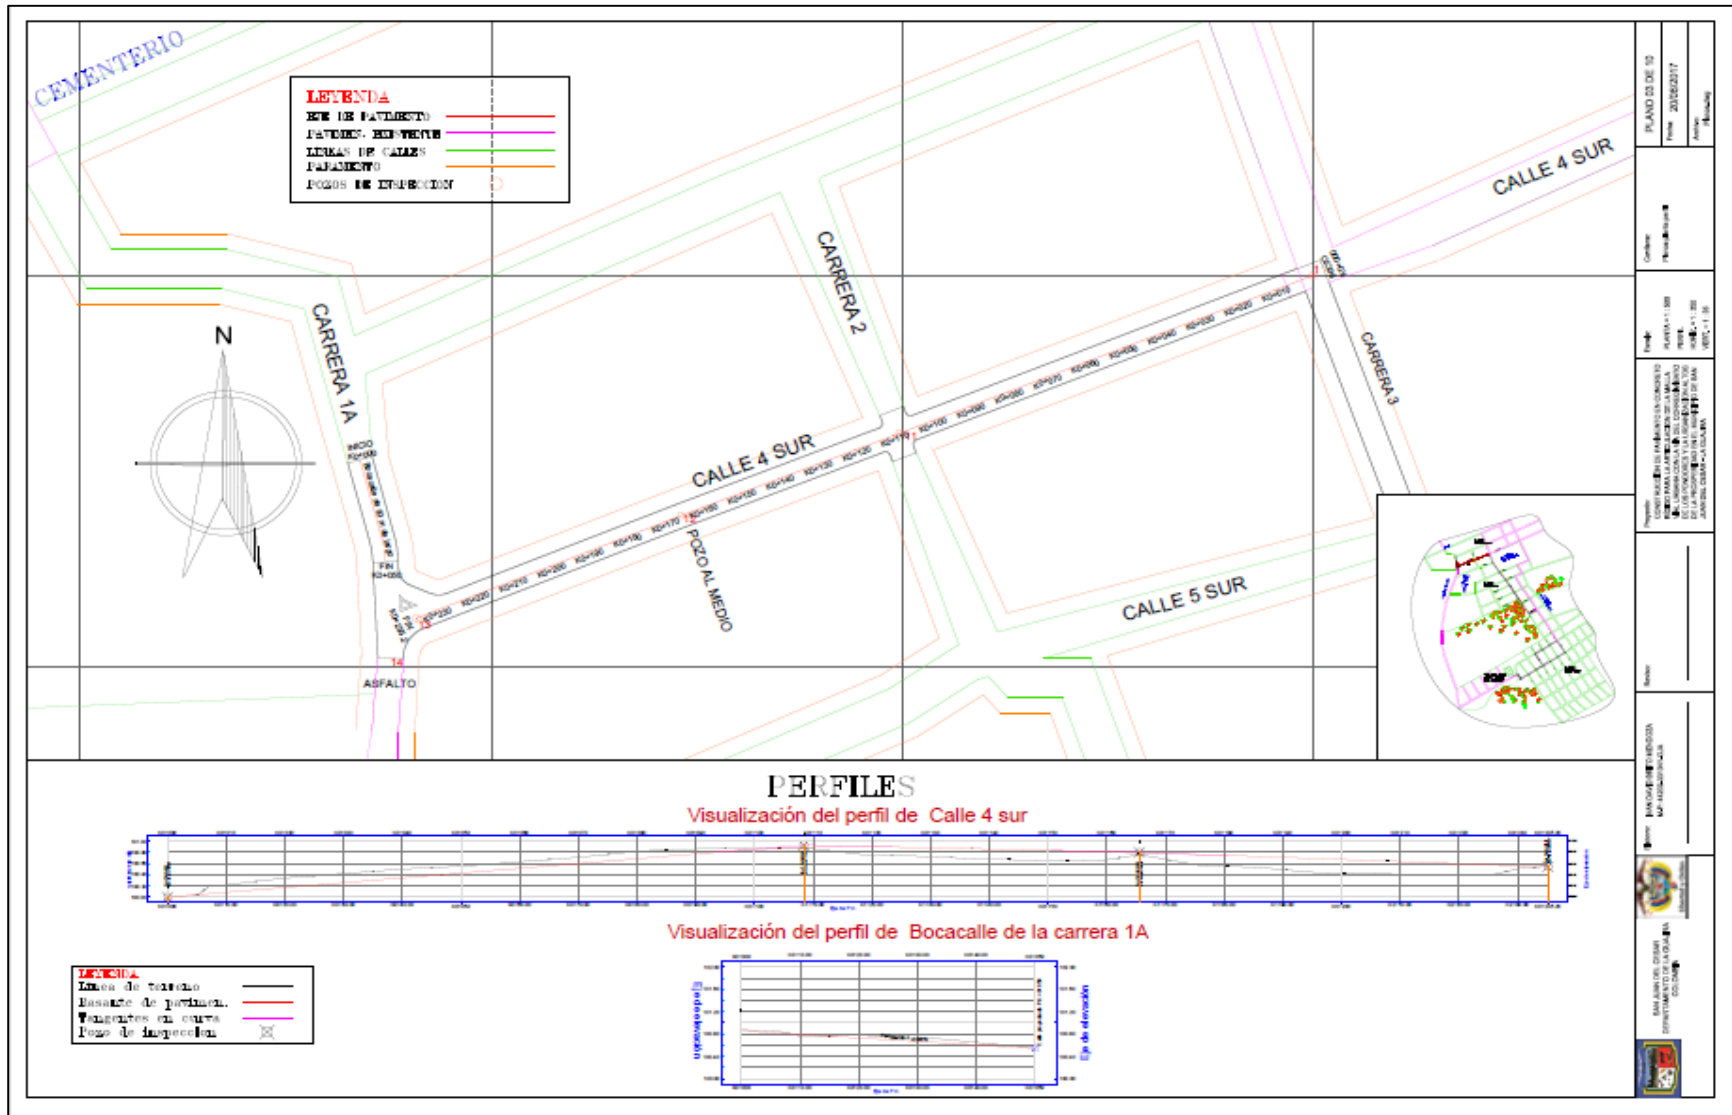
Plano del proyecto Calle 4 Sur. Fuente: (G24 SAS, 2017)
